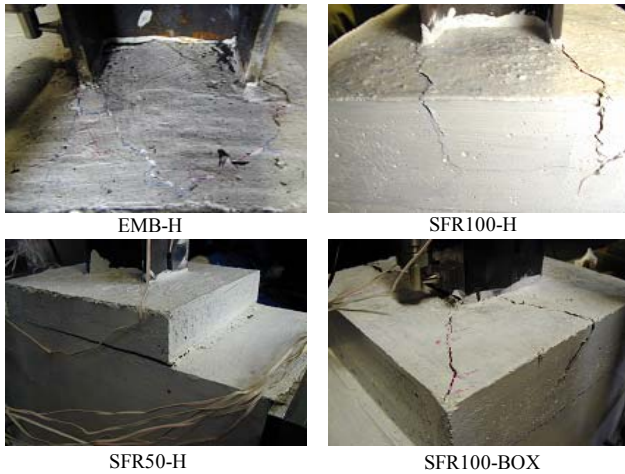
部材角 1/50rad 付近のひび割れ状況
